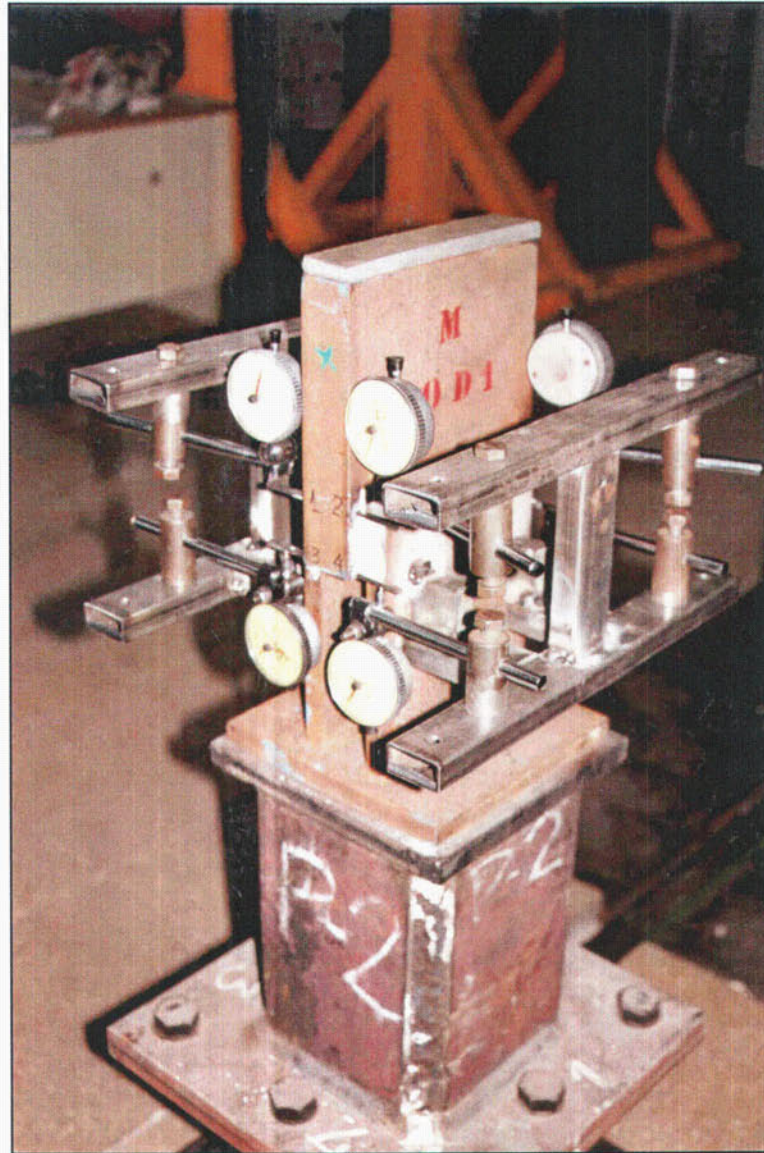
Probeta 1M con el equipo de flexímetros. En las soldaduras se ha realizado ya la pintura con cal.
